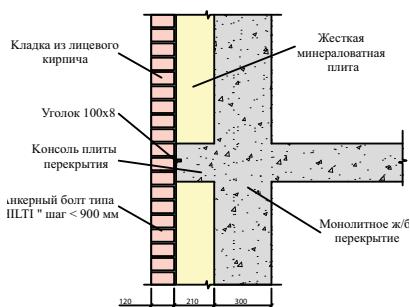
в Проектное решение узла крепления лицевого слоя кладки наружной стены к монолитной железобетонной стене
